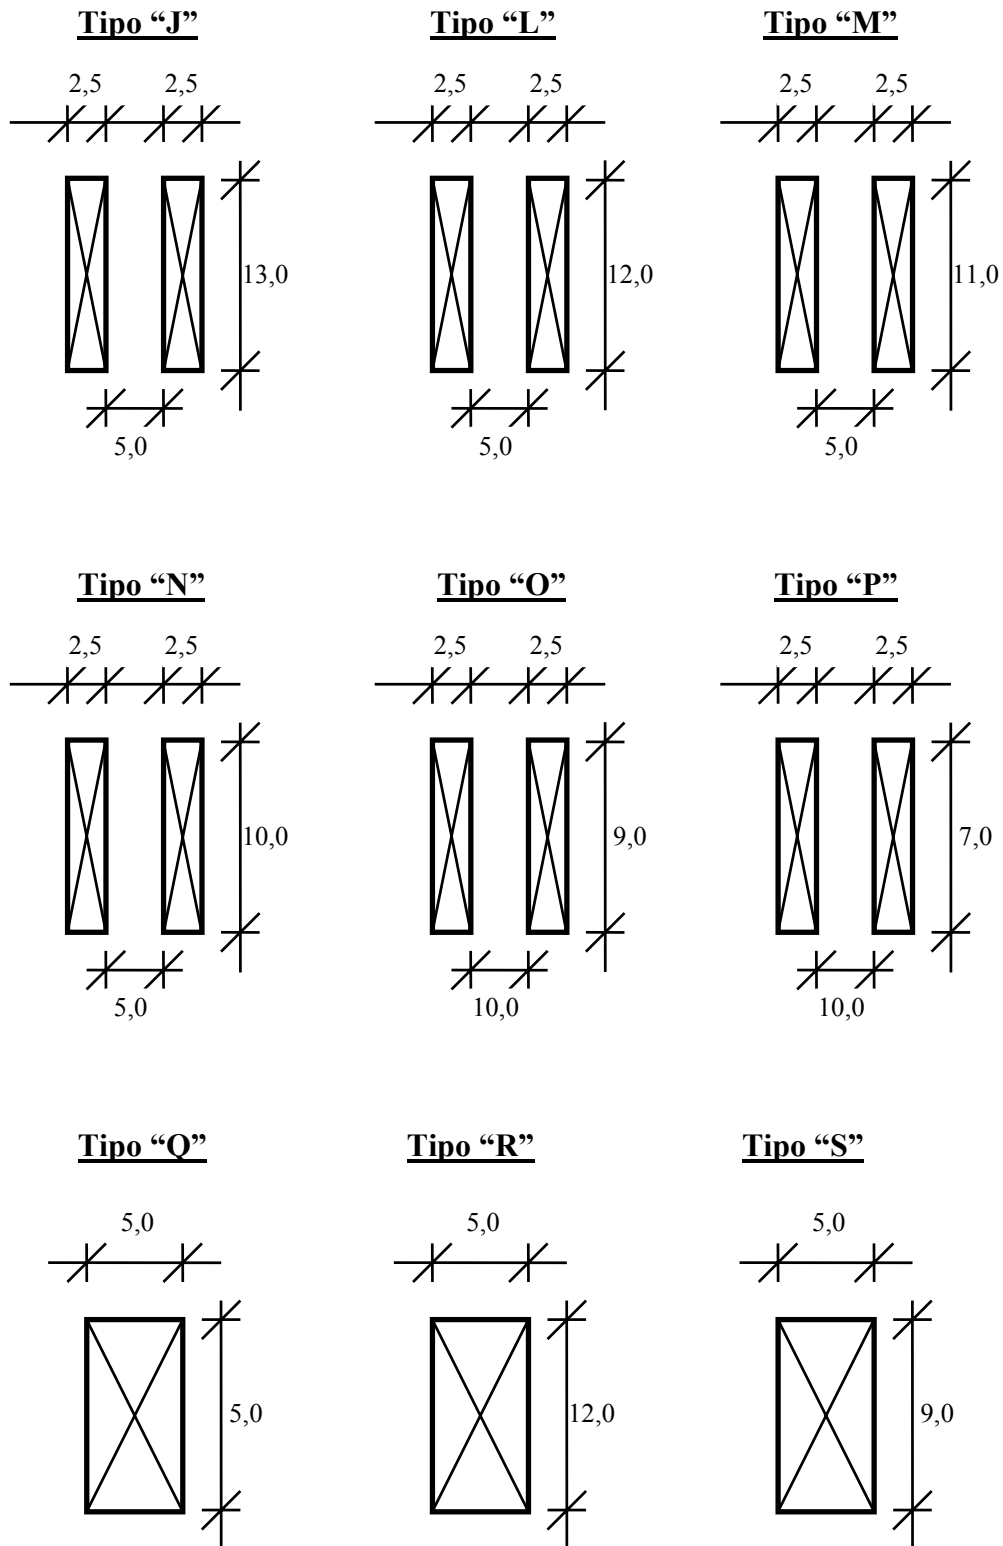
Tipos de seções transversais dos elementos estruturais
